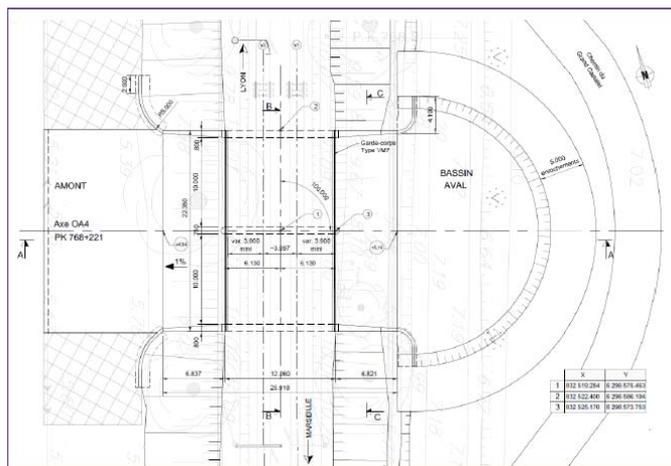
plan-type d'un ouvrage de mise en transparence hydraulique du talus ferroviaire.
